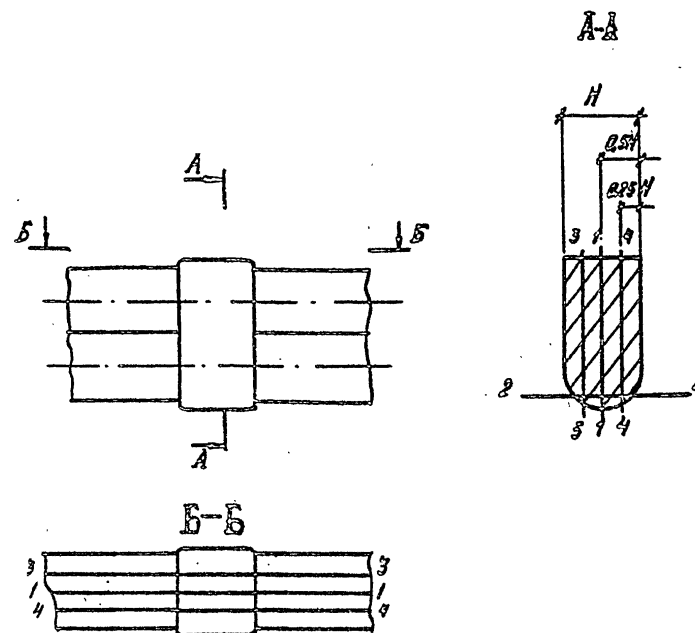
Схема послойного вскрытия сварного шва стыкового соединения спаренных стержней арматуры.
